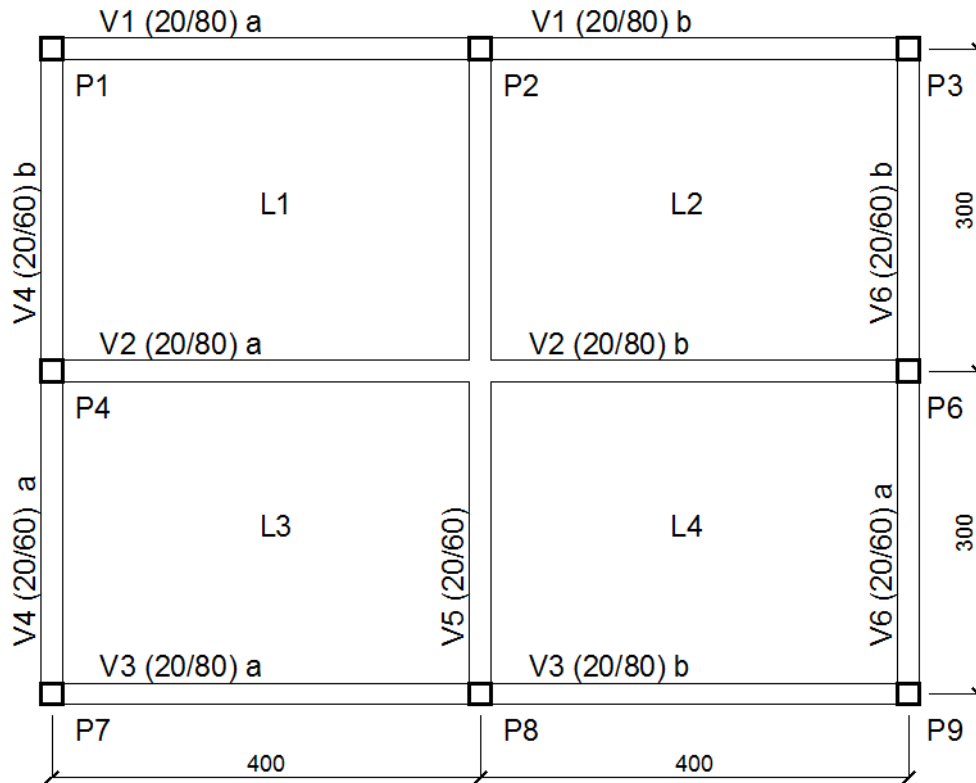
Exemplo 2 - Planta esquemática da forma do pavimento.
